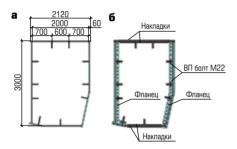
Поперечное сечение арочного свода (а) и монтажный стык (б)
